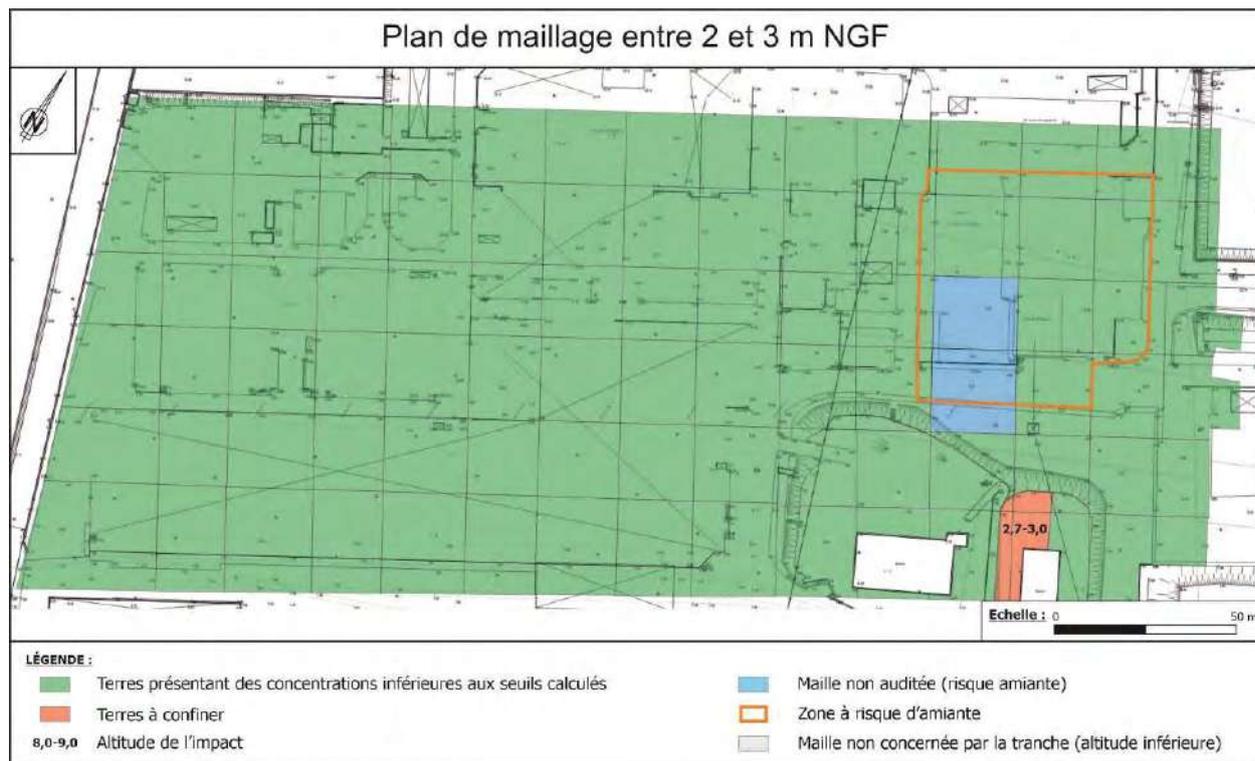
Plan de maillage entre 2 et 3 m NGF
